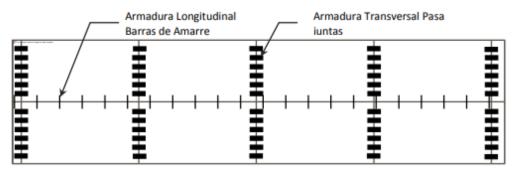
Localización en Planta de Pasajuntas y Barras de Amarre. Fuente: Citec Ltda.
